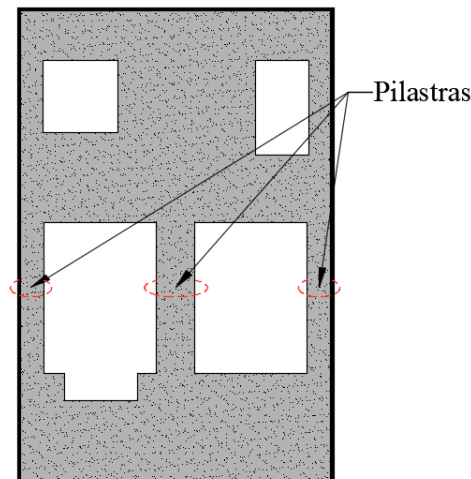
Pilastras de muros Tilt-Up
